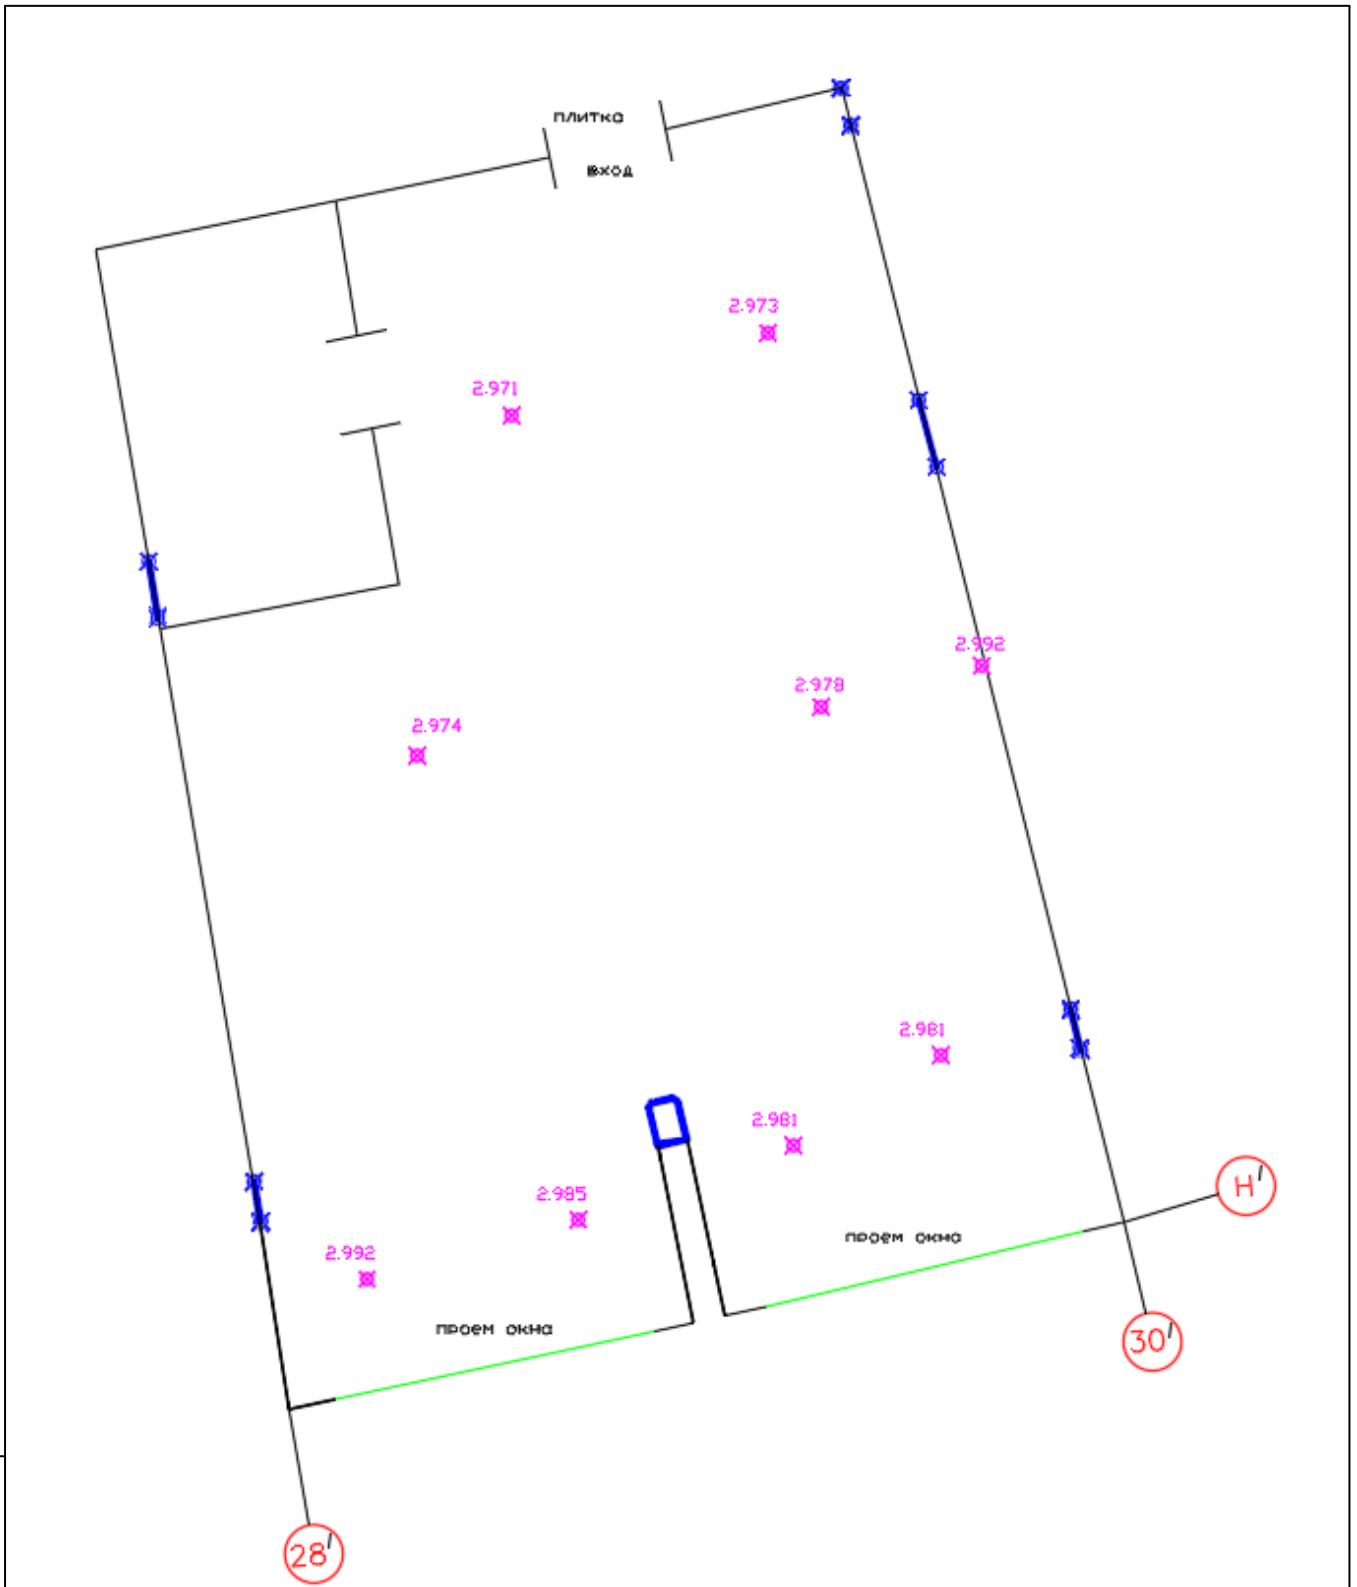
Отметки низа перекрытия в осях «28`-30`»
